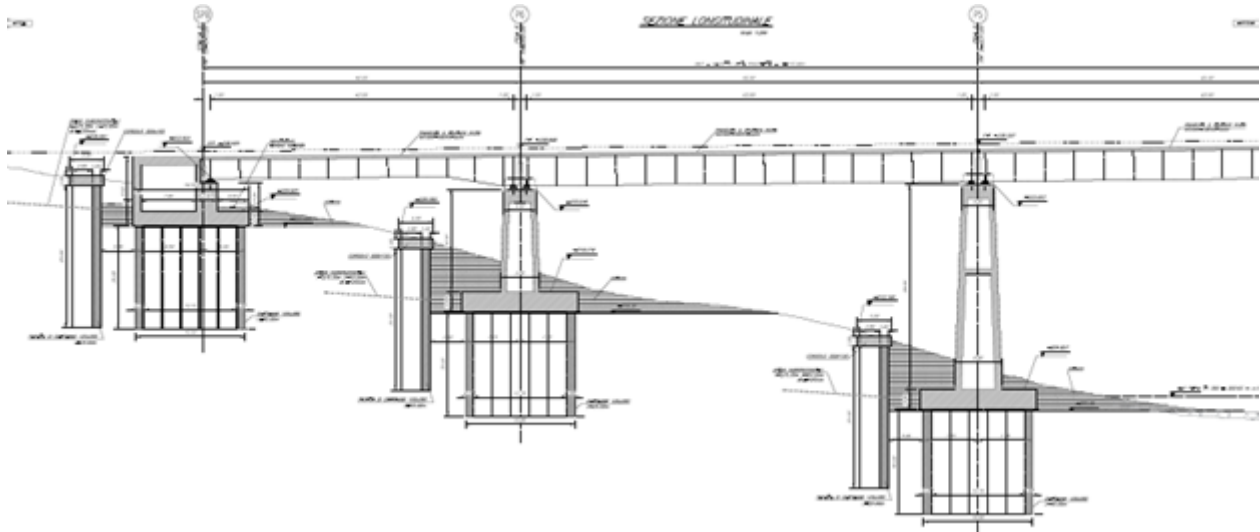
Sezione longitudinale di viadotto Ufita - Rocchetta
